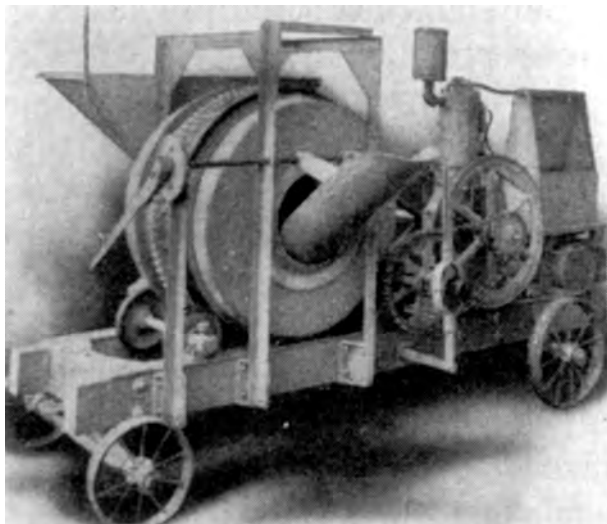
Ernest Leslie Ransome: Betoneira movida a gasolina. [Concrete International, maio de 1996 v. 18 issue 5]: 51
